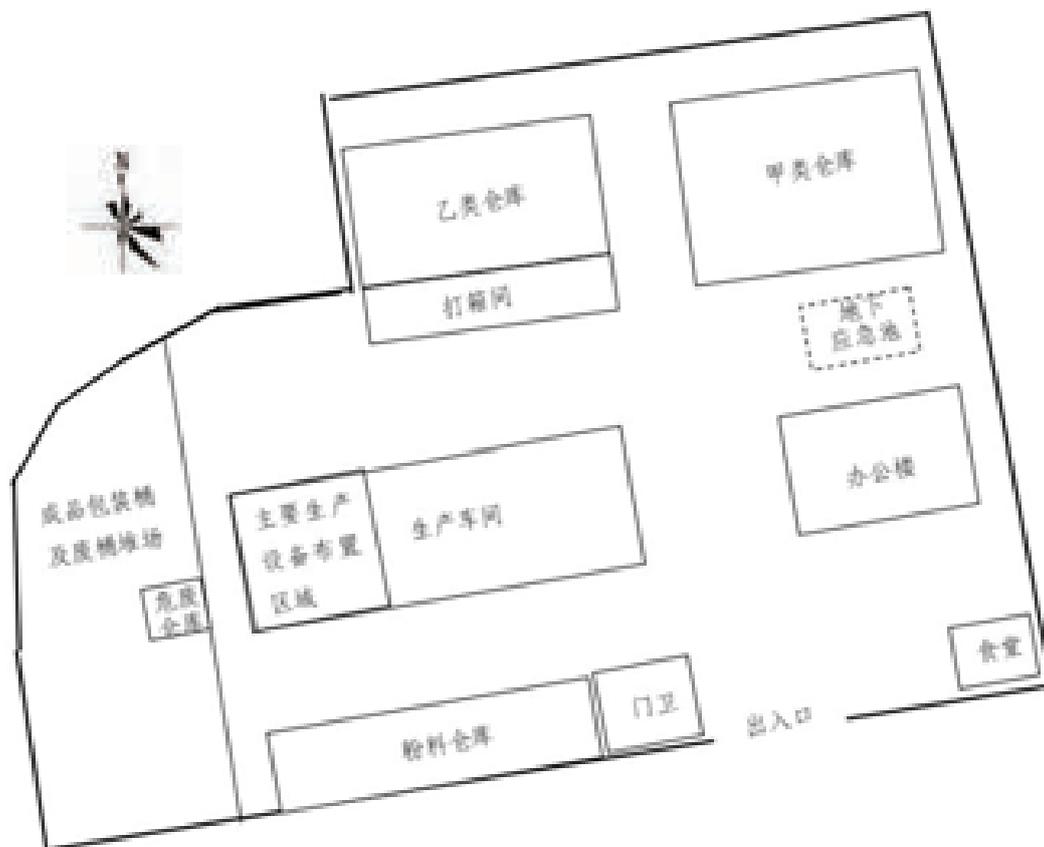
海宁市船舶油漆厂厂区平面布置图
